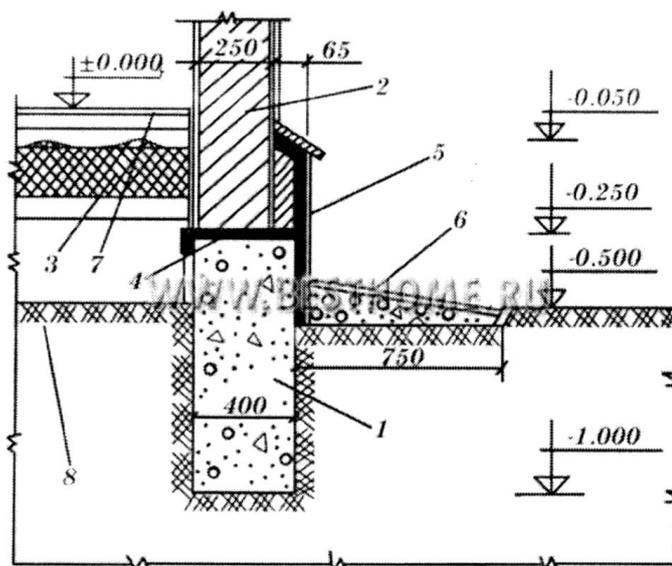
Ленточный фундамент из монолитного бетона: 1 - ленточный фундамент из монолитного бетона марки 100 (ширина - 40 см, высота – 75 см, глубина заложения в грунт основания - 50 см; 2 - стена; 3 - утеплитель (насыпной.); 4 – гидро-изоляция (толь, рубероид); 5 - цоколь; 6 - отмостка; 7 - покрытие пола; 8 – грунт.
